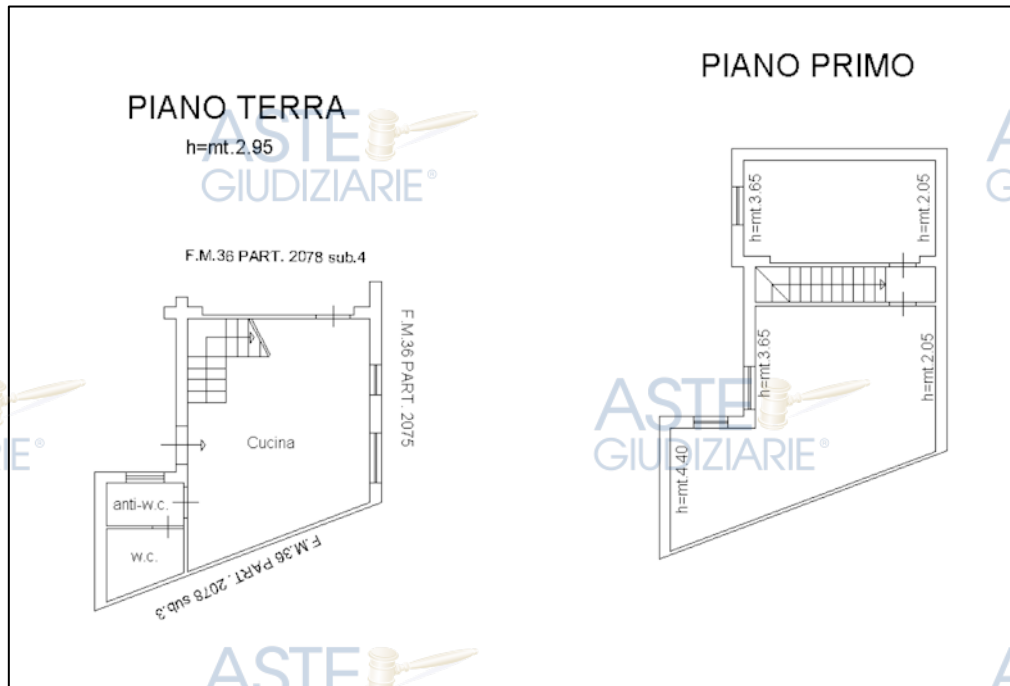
Estratto planimetria catastale sub 5 (ALLEGATO 4)
